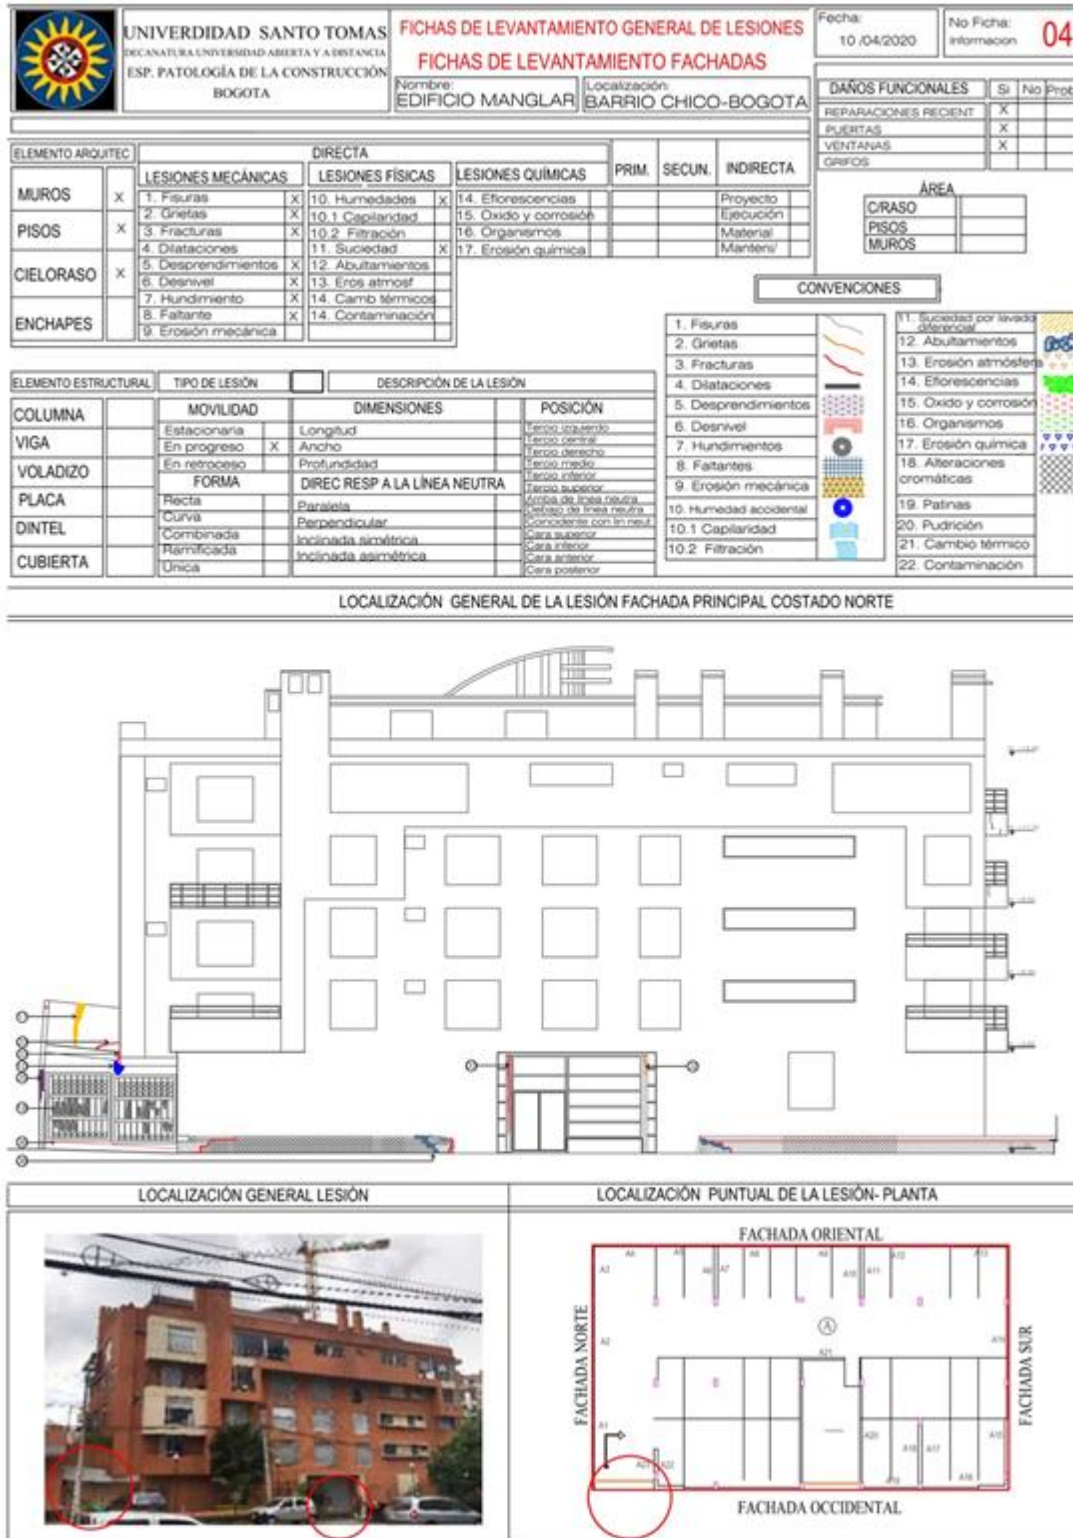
Fichas Levantamiento de Daños Generales en Fachada. Fuente: Elaboración propia
